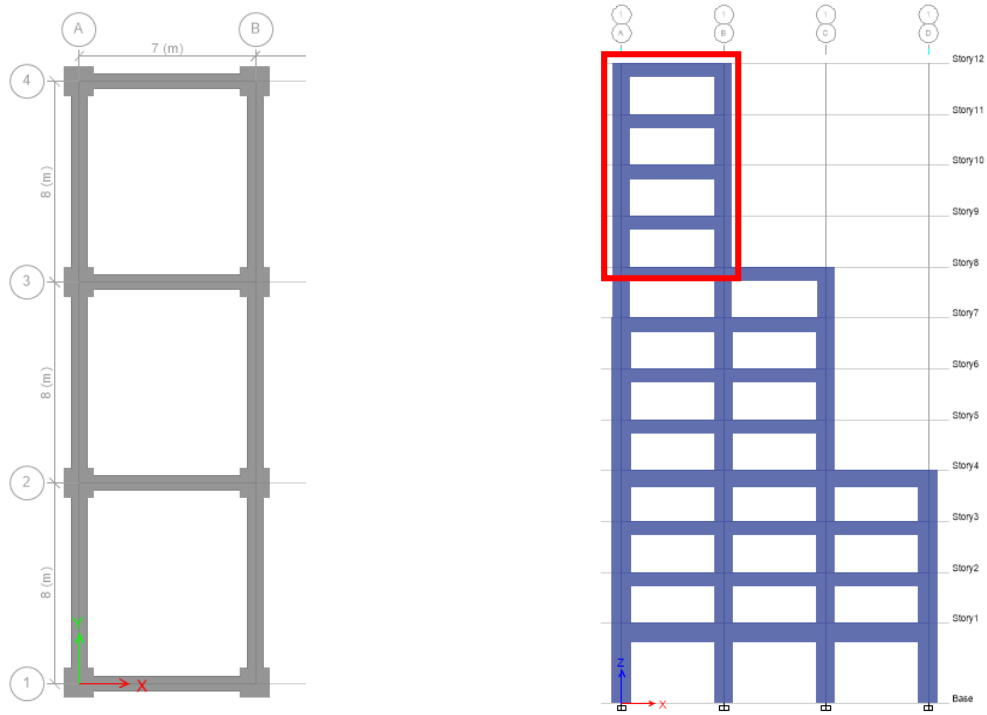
PLANTA DEL NIVEL 9 AL NIVEL 12
